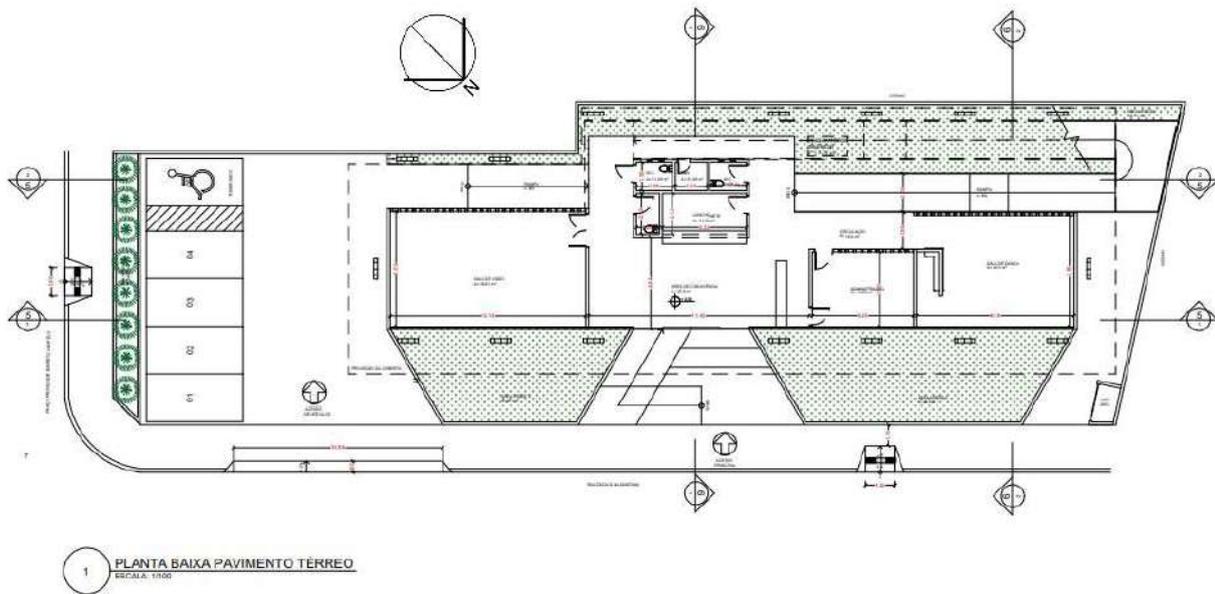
Centro de Educação e Cultura da Torre - Planta baixa – Pavimento térreo
